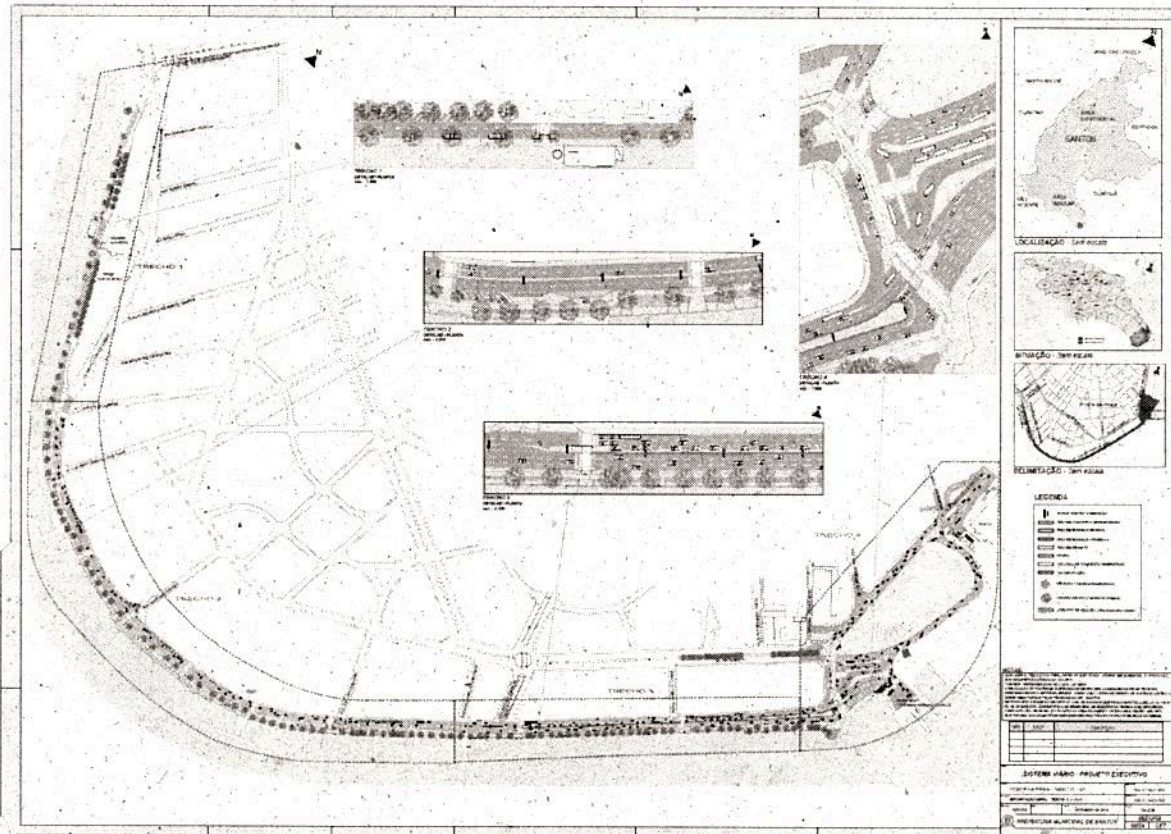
Planta geral da área diretamente afetada pela proposta interventiva, considerando a arborização existente.
